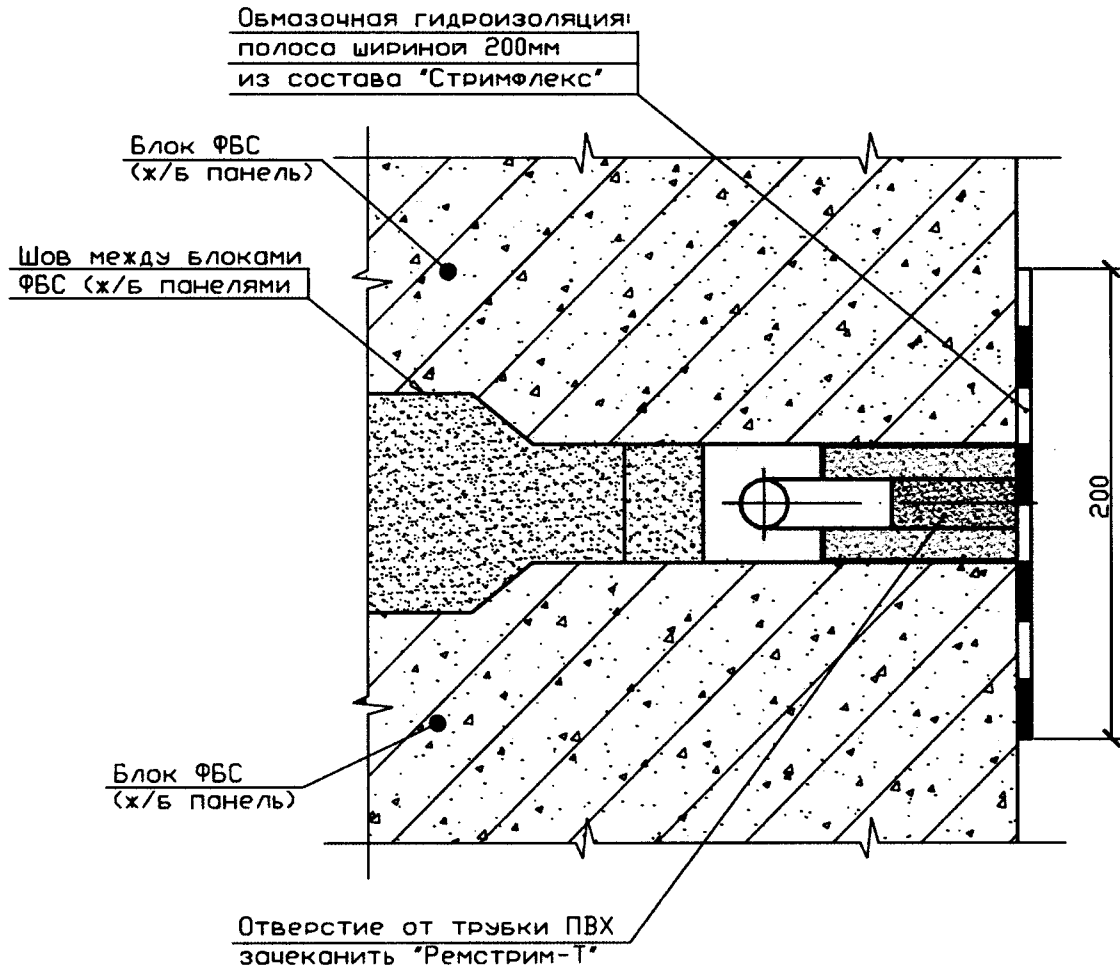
Герметизация между сборными конструкциями (блоками ФБС, ж/б панелями). Заделка отверстия от трубки ПВХ и обмазочная гидроизоляция шва
